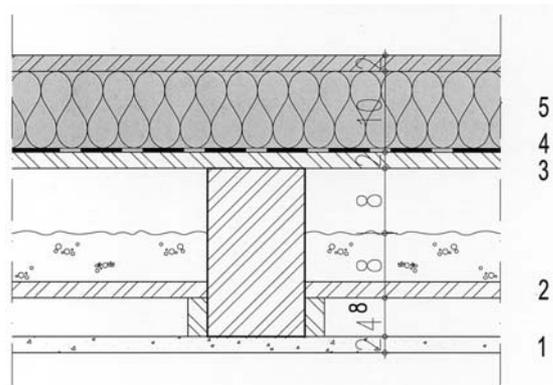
Einbindende Bauteile im unausgebauten Dachraum
